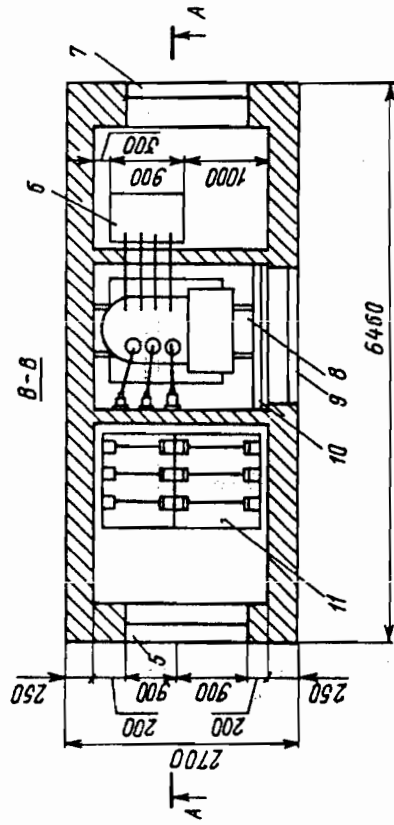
Габаритные, установочные и присоединительные размеры подстанции ЗТПС-10-1Т2В:
